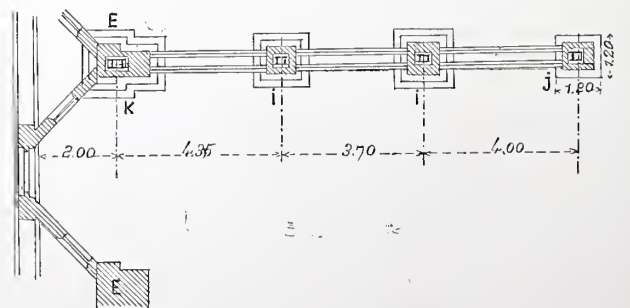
Plan des fondations. Echelle de 0,005 par mètre.
